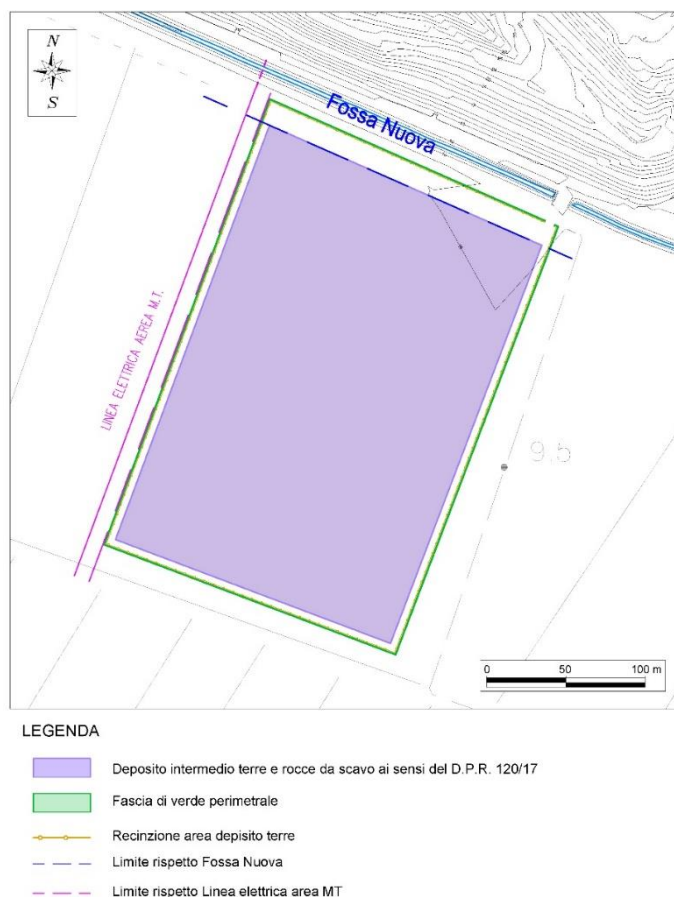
7 – Planimetria aree di deposito intermedio terre ai sensi del DPR 120/17
